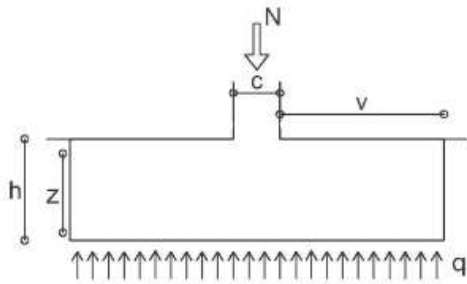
Esfuerzos en una zapata aislada sometida a compresión.
